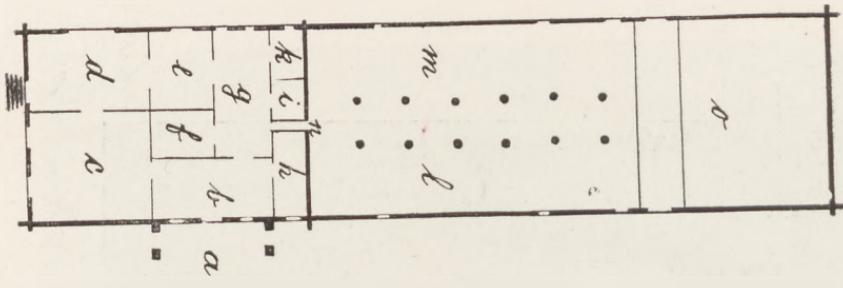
Grundriss eines Langhauses aus Weißhof um das Jahr 1800.
